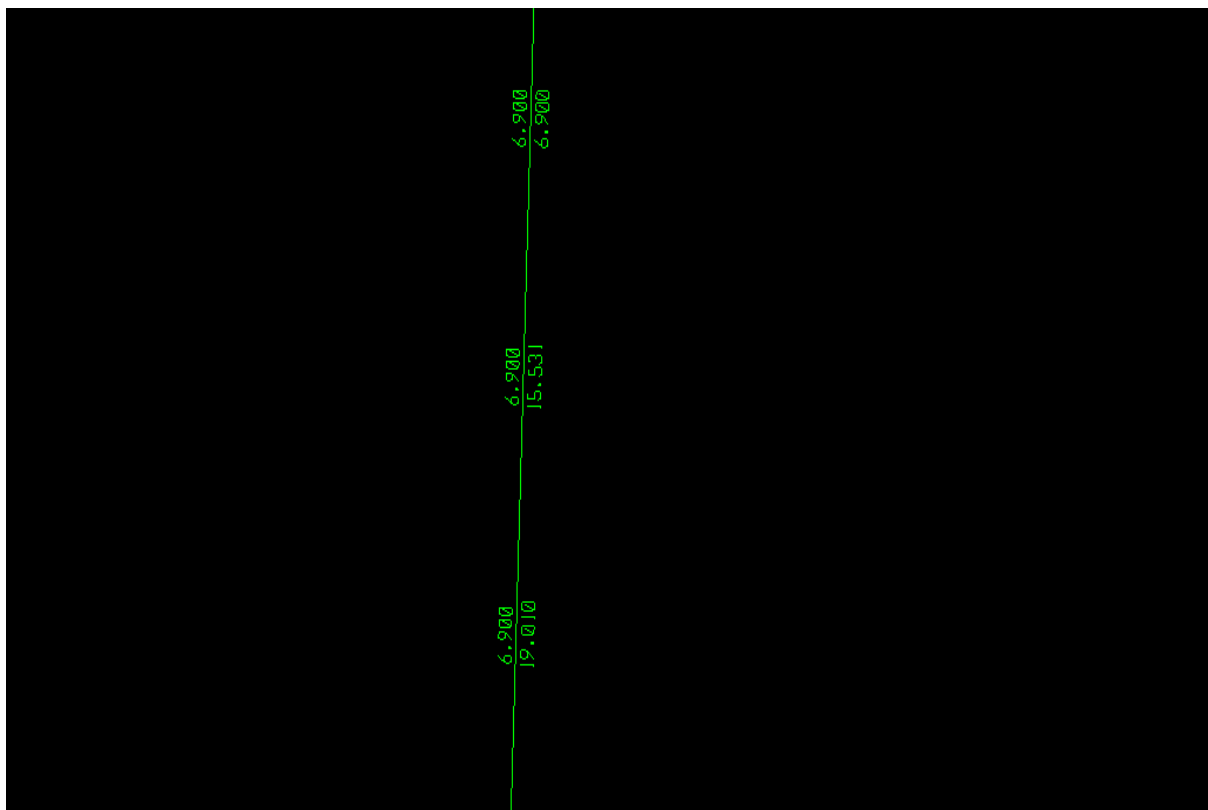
Ferrailage du tronçon le plus sollicité du pied droit (cas statique)
